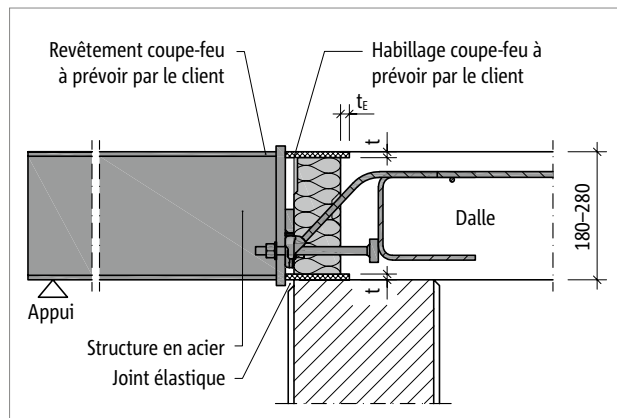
Schöck Isokorb® T type SQ : habillage anti-feu prévu par le client pour l'élément T type SQ, structure en acier munie d'un revêtement de protection incendie ; vue en coupe
